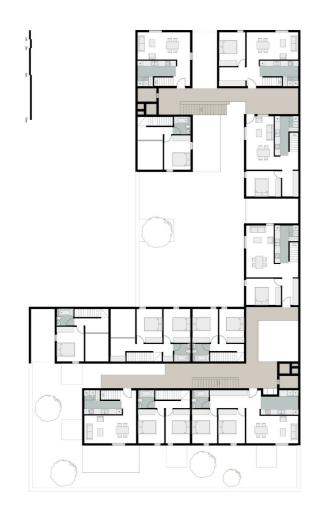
Zonas Húmedas, Primera Planta Alta Fuente: Autores, 2022
